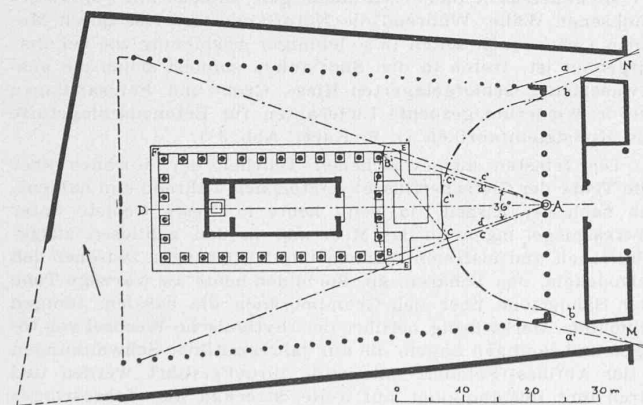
Römischer Tempel von Palmyra, 1. Jahrhundert v. Chr. Grundriss 1 : 1000
